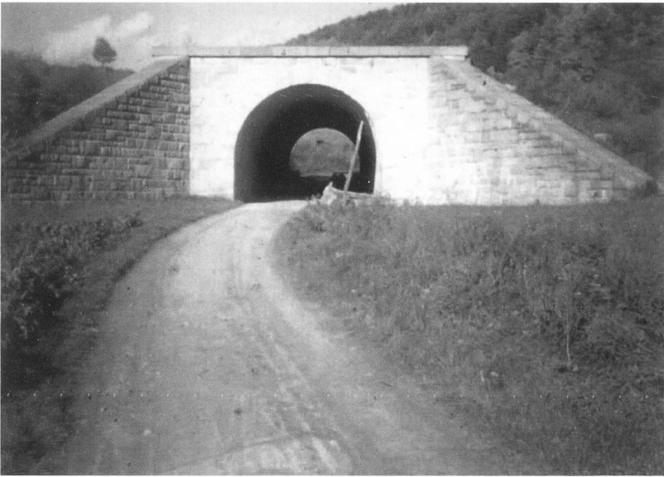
Tunnel Kiefenholz mit Blick zur Dorfstraße
